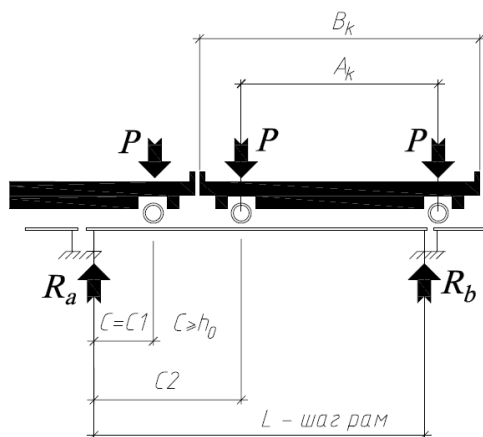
б Неблагоприятное расположение кранов для наклонного сечения подкрановой балки с пролетом 6 м.
